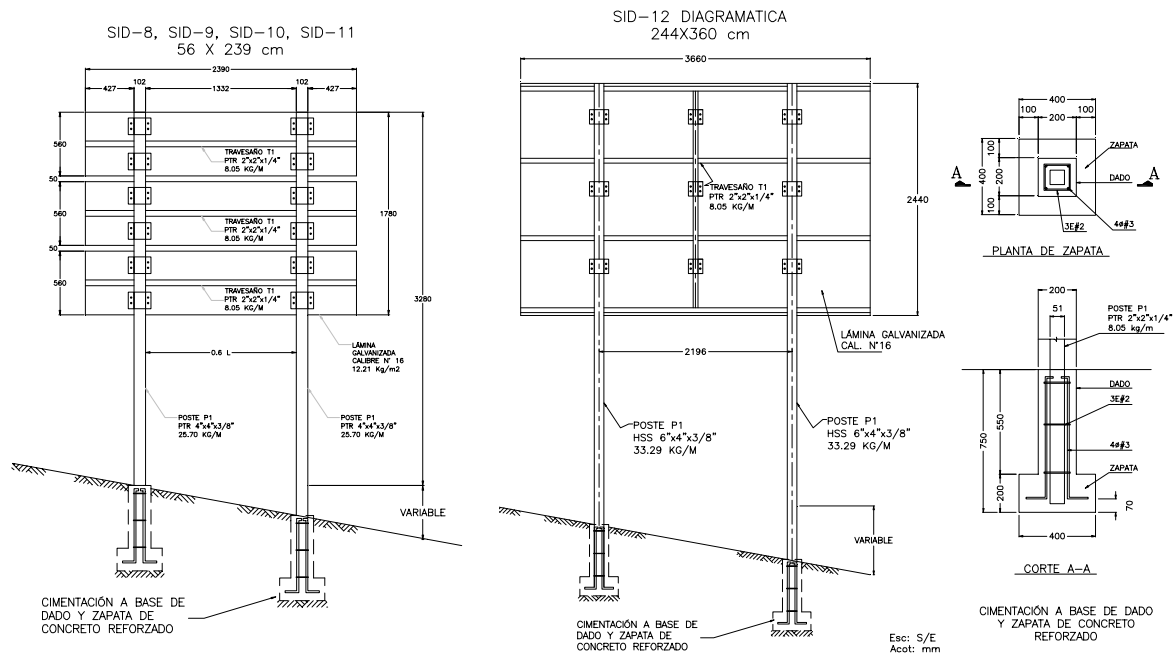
Detalle de la estructura de soporte y cimentación de las señales informativas de destino SID
